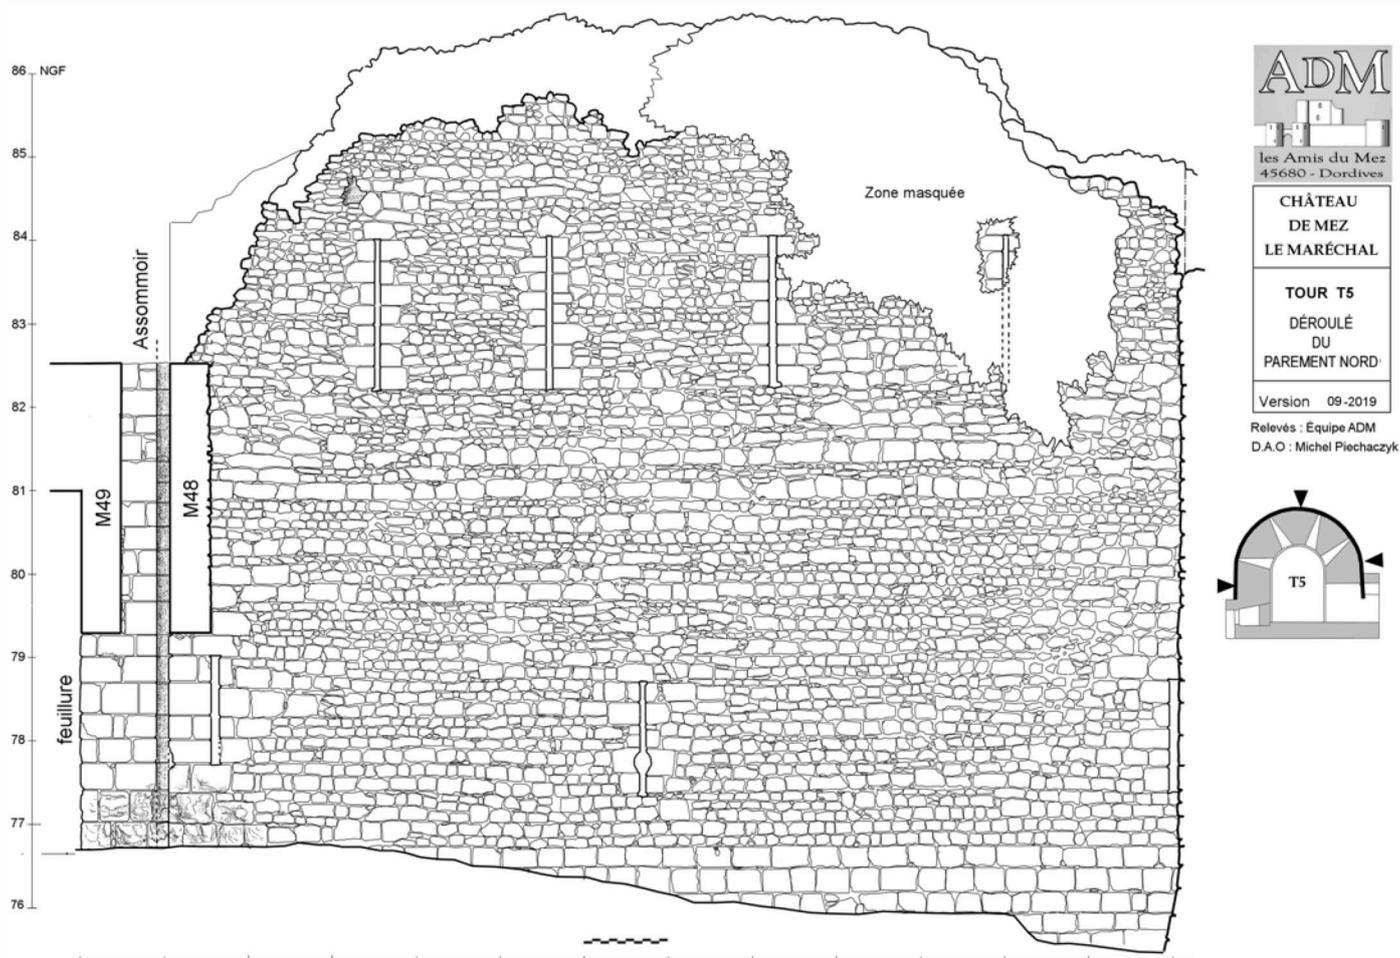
Relevé pierre à pierre du déroulé de parement de la tour T5
